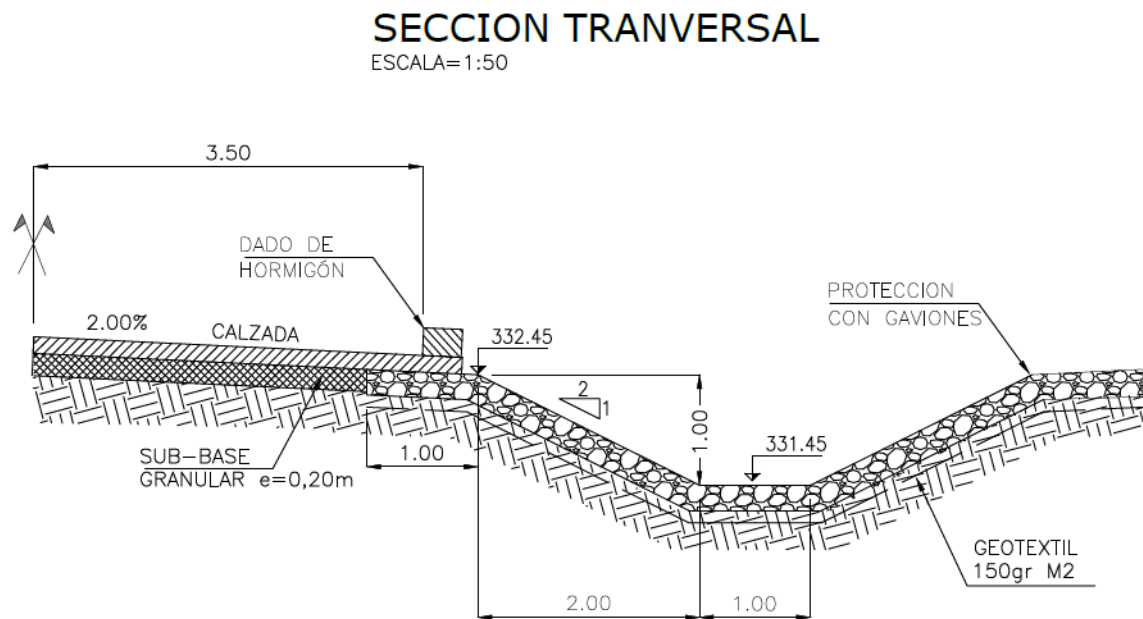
Detalle de protección en el canal en intersecciones con las calles afluentes.
